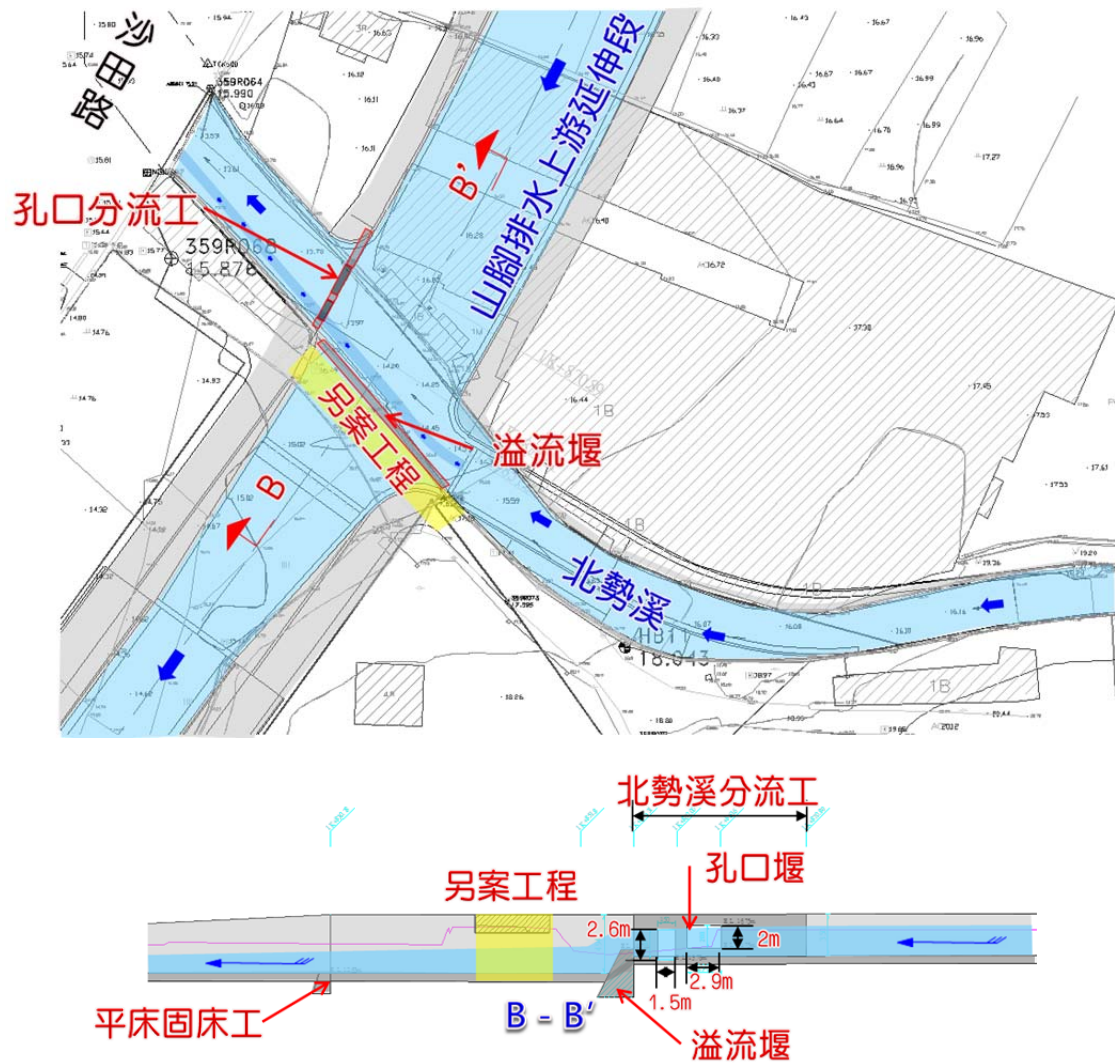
北勢溪未改善前施工規劃平面及剖面圖(二)
